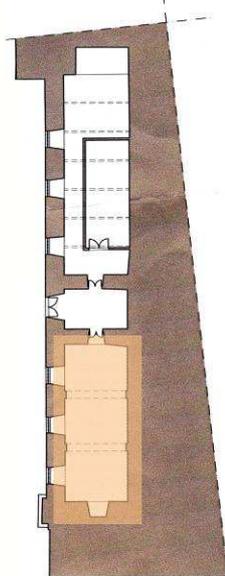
Localização da sala Poente na planta do criptopórtico do levantamento de 2003.
